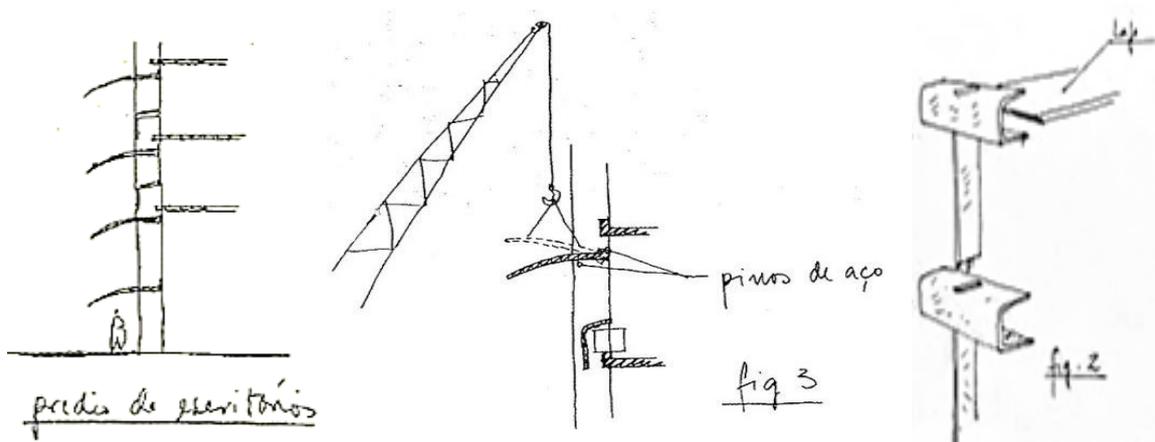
Esquema de piezas prefabricadas y montaje a utilizar en fachada de edificio vertical
